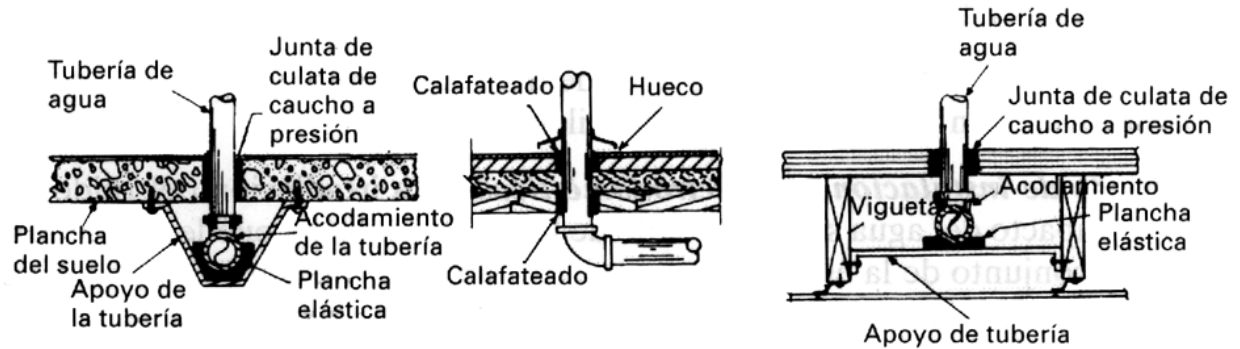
Distintas técnicas para aislar una tubería de la estructura a la que se sujeta.
